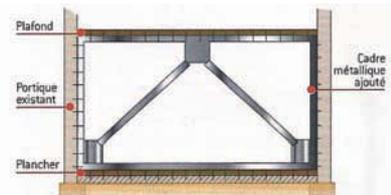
Exemple de renforcement du contreventement par ajout de croix type K ou Saint-André en charpente métallique ou en poutre de béton armé à un portique existant (coupe transversale)
